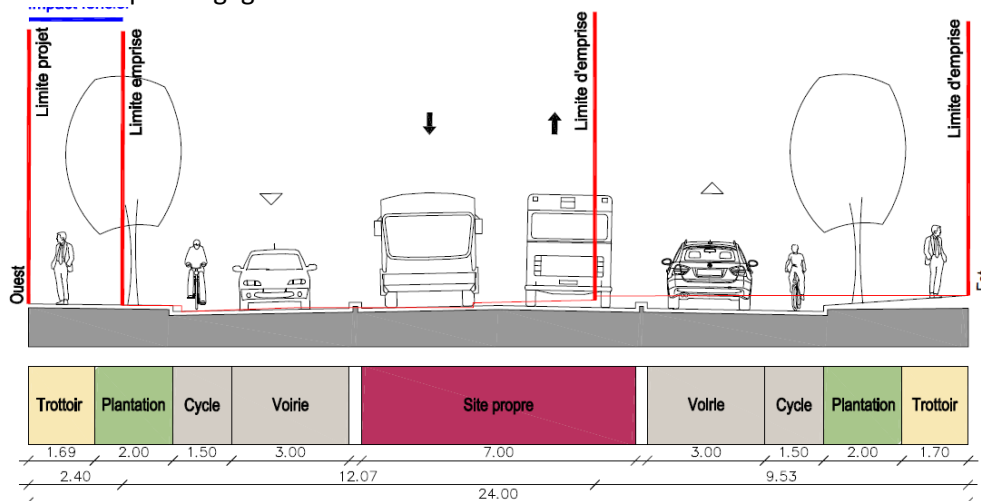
Coupe type en section courante sur la RD392¹⁷
